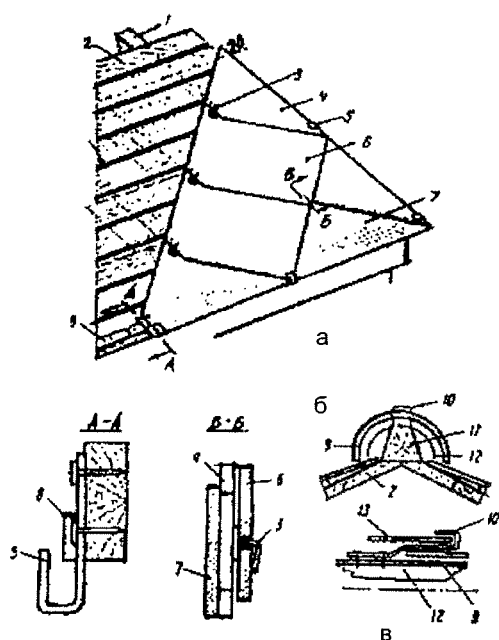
Конструкция кровли из асбестоцементных плоских плиток
